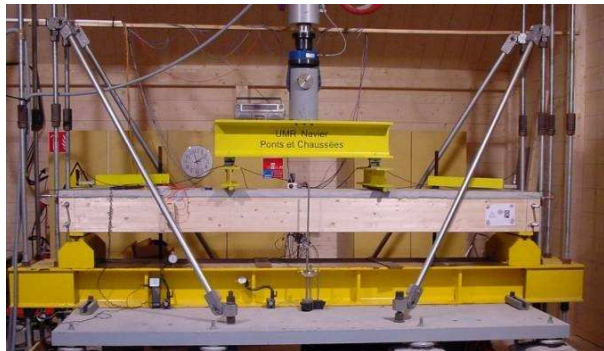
La poutre mixte en bois-béton considérée (3.2m) et le dispositif d'essai
